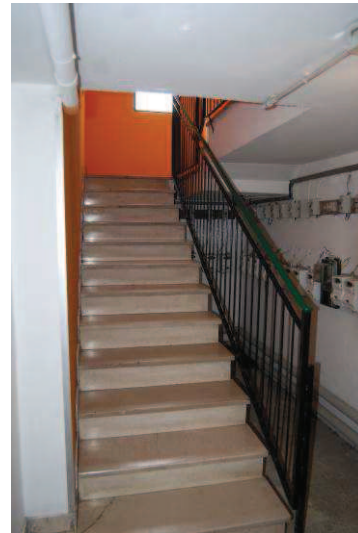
scale di accesso alle cantine e zona contatori corrente elettrica
